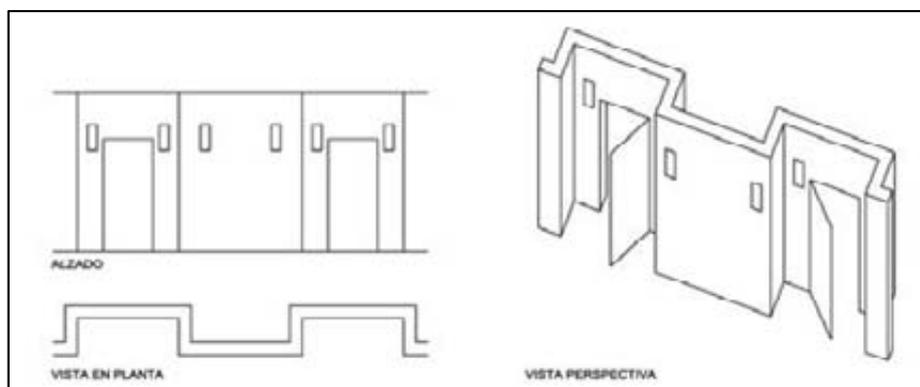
Vista en planta, alzado y perspectiva de la muralla de la obra *La caída de Babilonia*.
